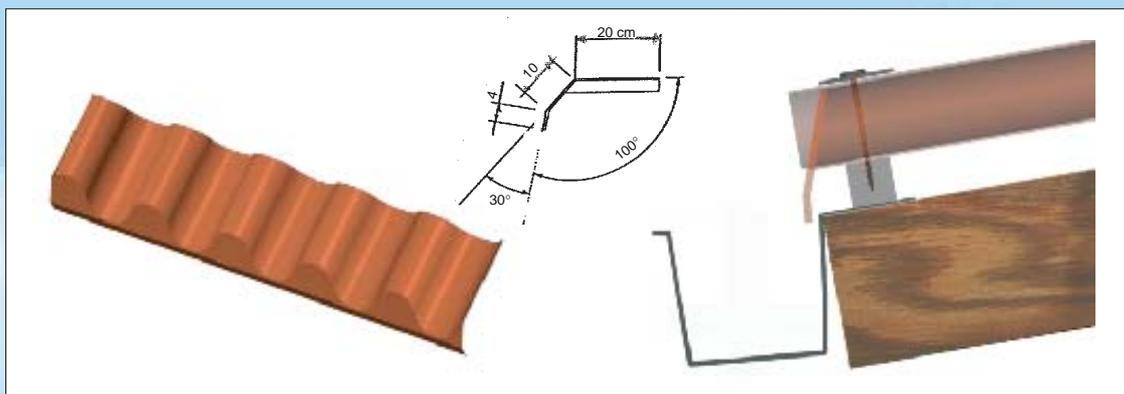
Colmo di gronda. Schema installazione colmo di gronda.
